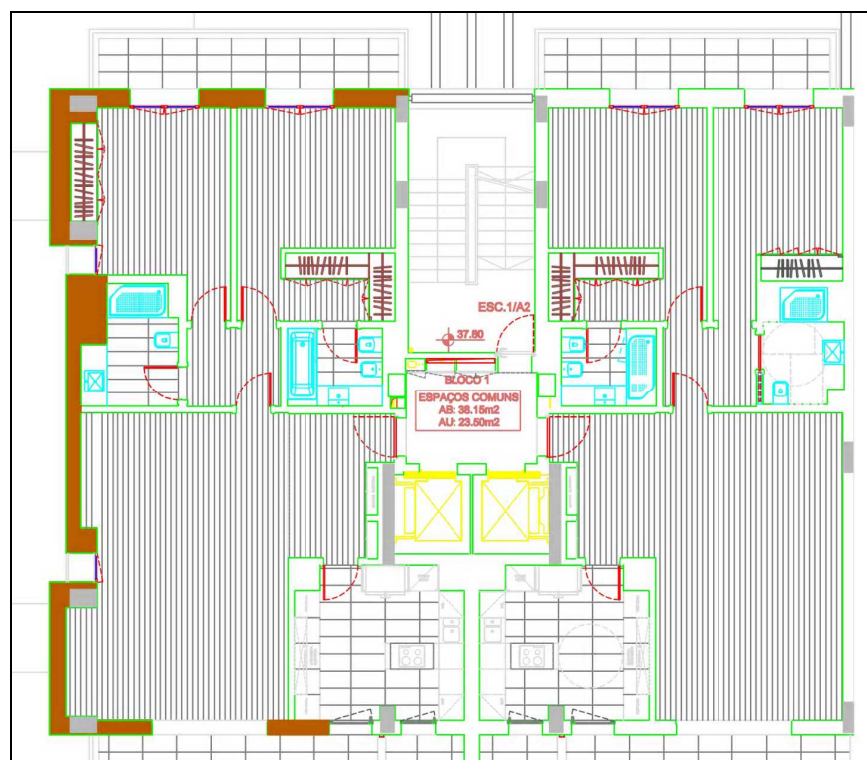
1 - Planta de apartamento T2 (paredes exteriores)
